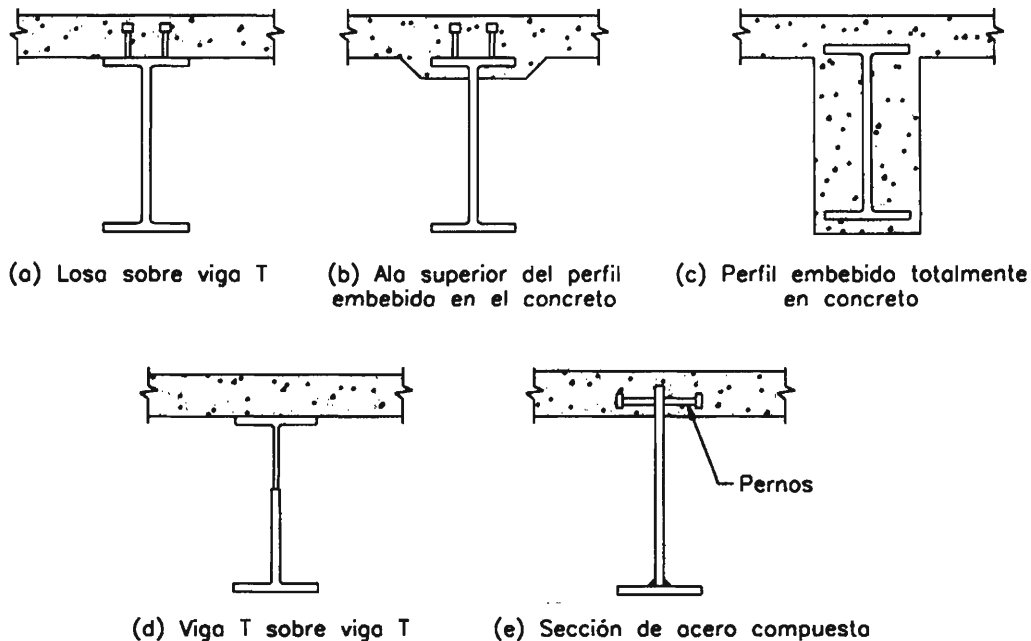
secciones comunes de vigas compuestas de acero y concreto
